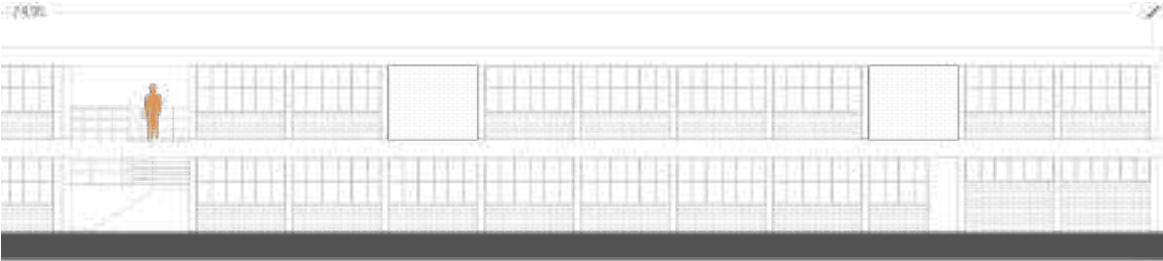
Plantas y alzados arquitectónicos de la construcción actual del Edificio I.
